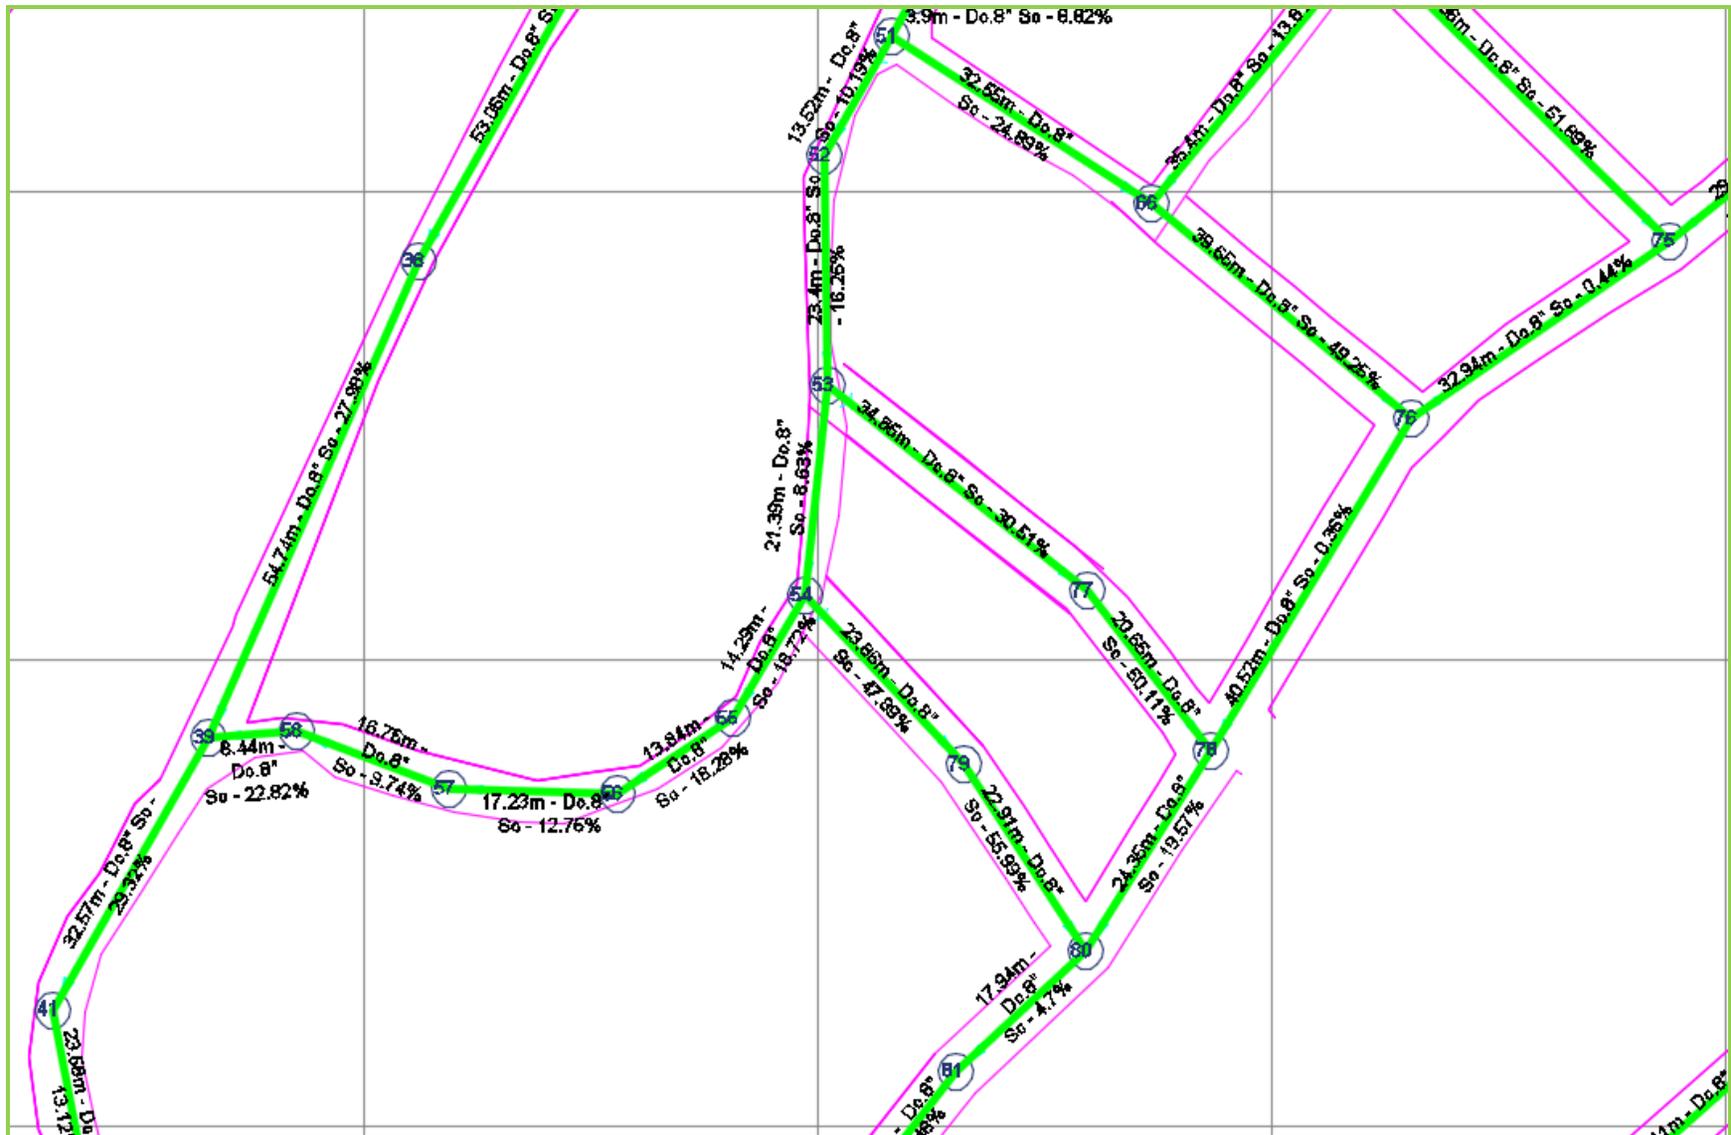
Detalle Diseño de Alcantarillado L-D-S-PzN
